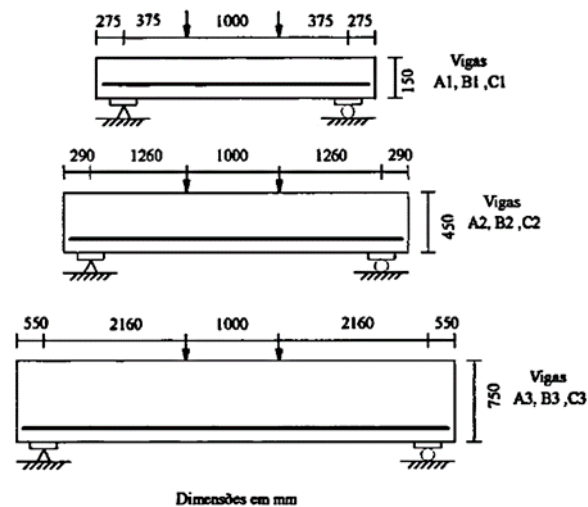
Detalhamento do sistema de ensaio (WALRAVEN, 1984)
